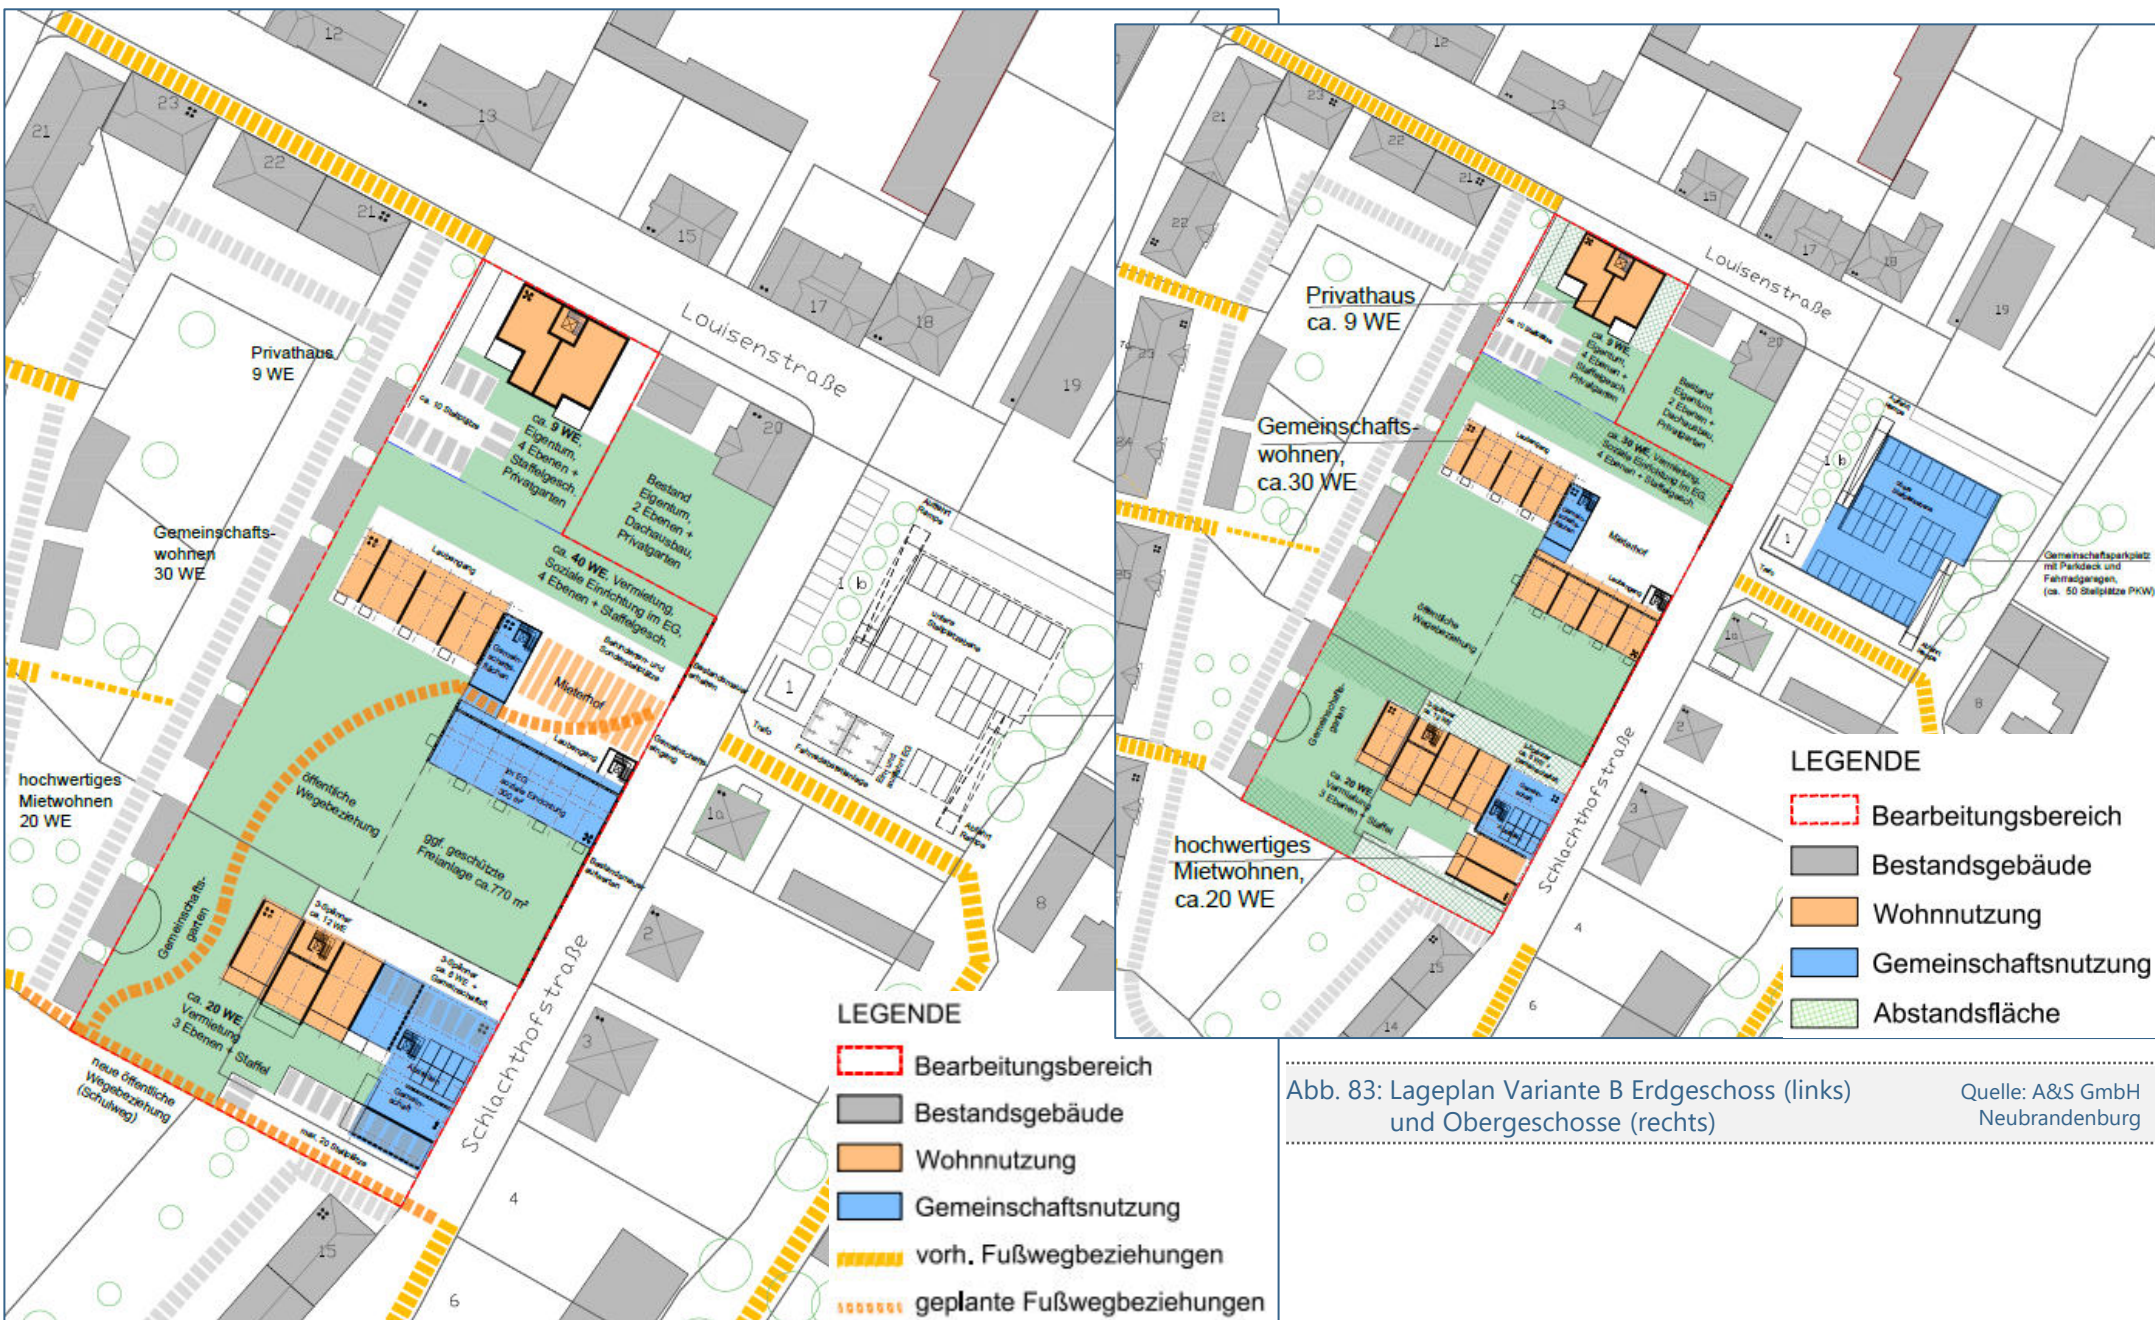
Lageplan Variante B Erdgeschoss (links) und Obergeschosse (rechts)
